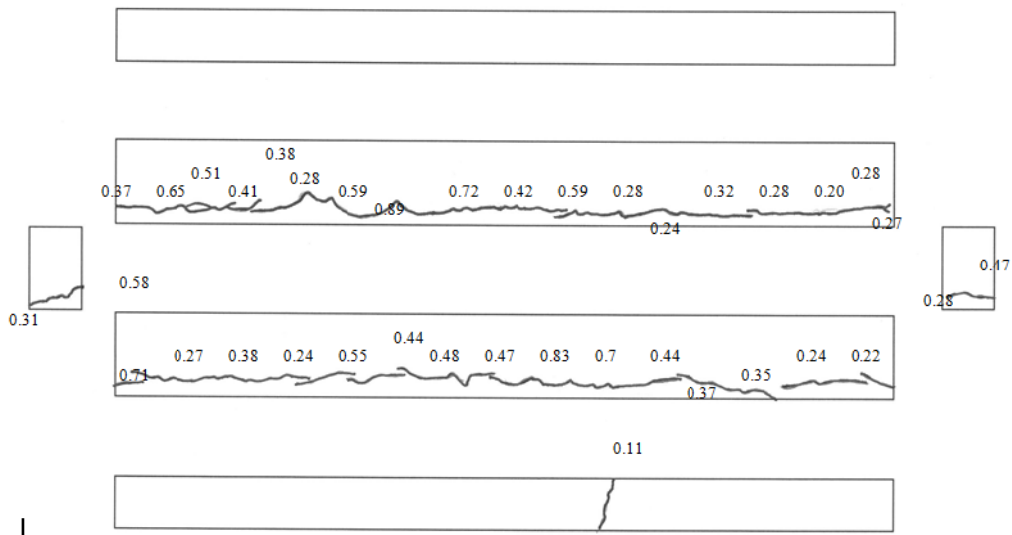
Schéma de fissuration de la poutre (2T12 30 kN) avec les ouvertures des fissures de corrosion en mm.
